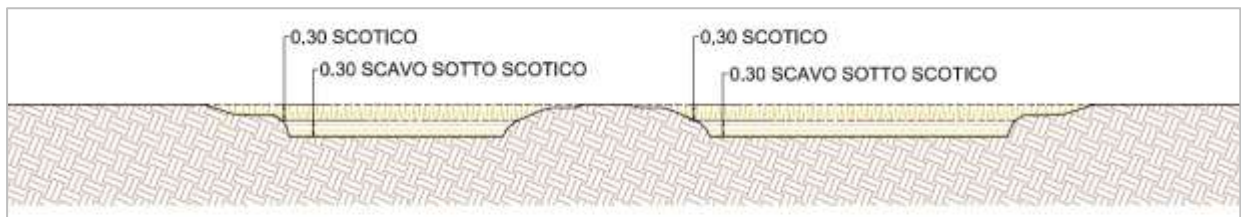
Sezione tipo di progetto (tav. M.P.3)
